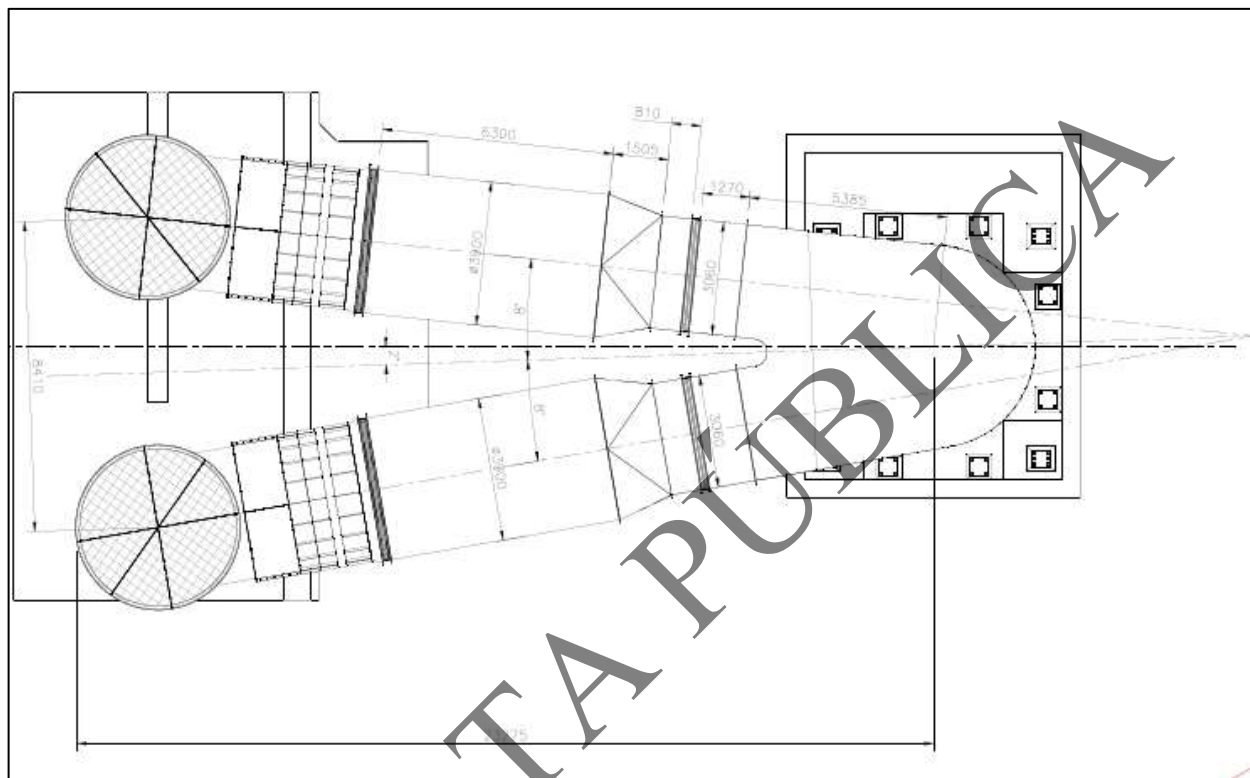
9. Vista cenital de la planta de cimentación con el extractor de ventilación
